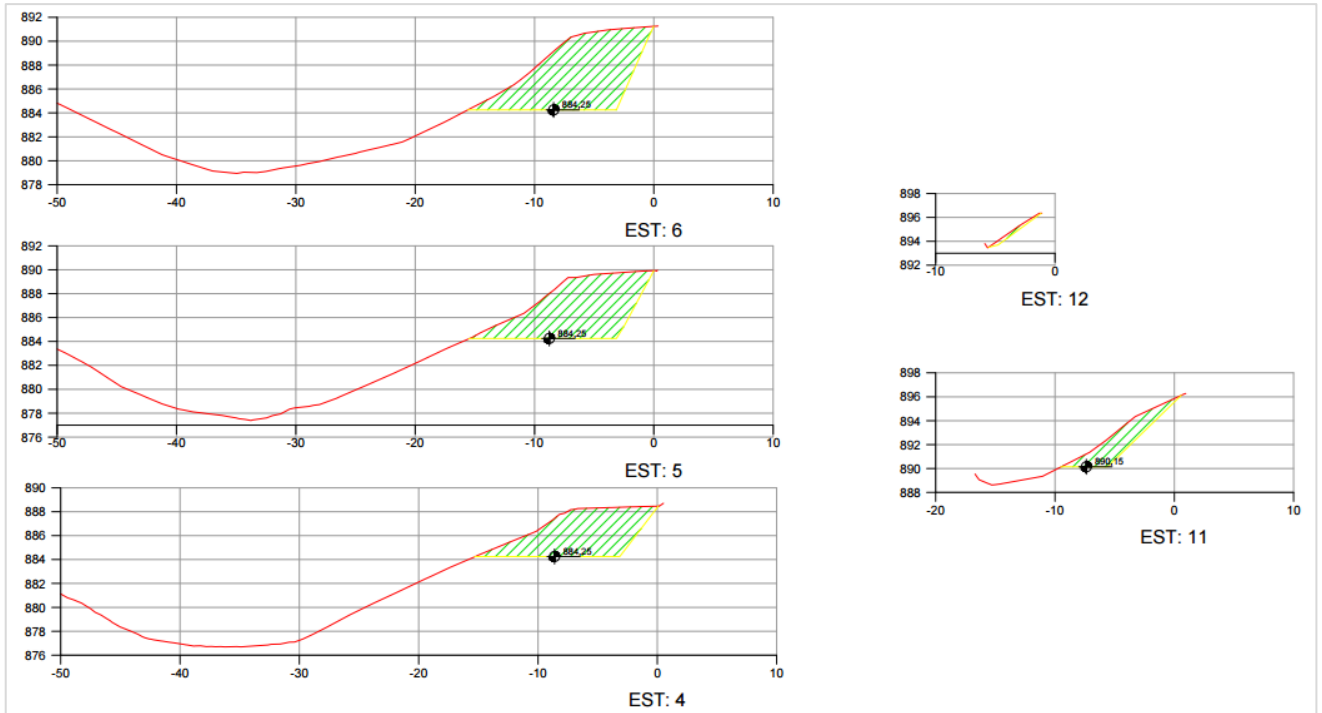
Seções do projeto de terraplenagem (Fonte: arquivo "Azimute_-_Projeto_T.pdf").
